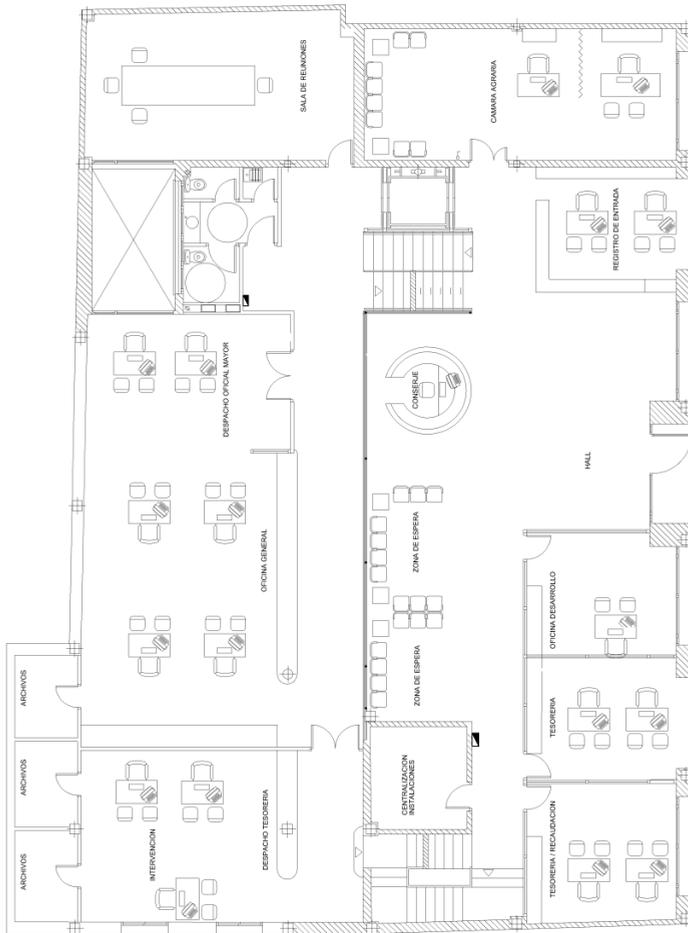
Distribución de Plantas Baja y Primera. 2002. AutoCAD.
